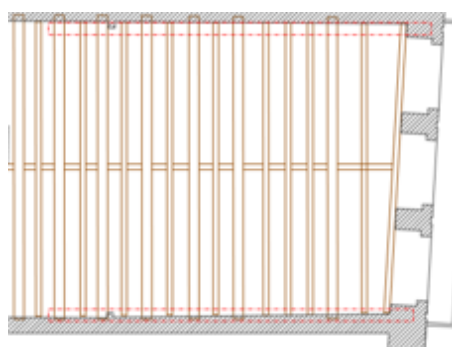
planta estrutural do pavimento PVC_1
